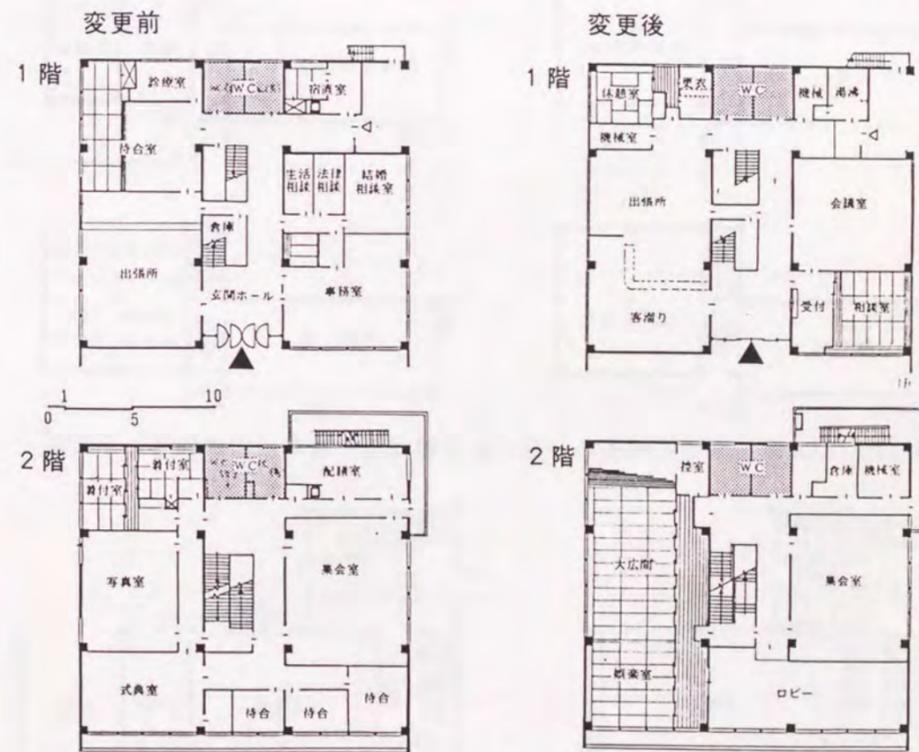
<64>足立区東部区民福祉センター(旧結婚式場)1,2階平面図
